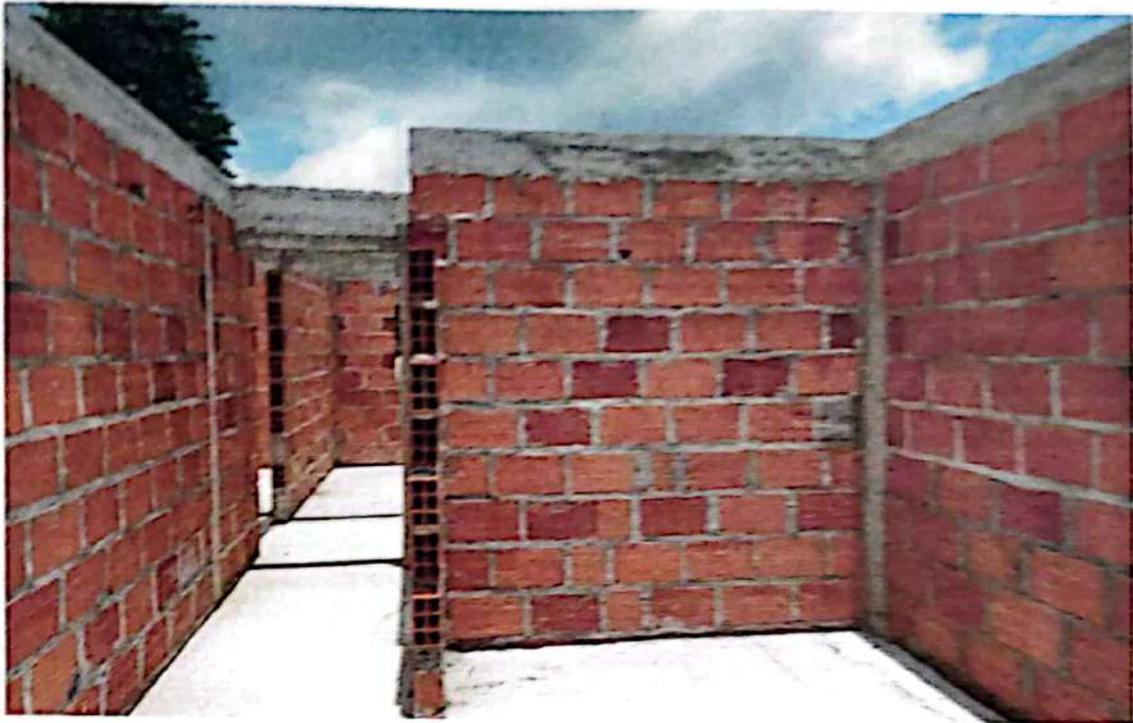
Vista baño tipo terminado en ladrillo H:10 a la altura de viga corona, con vista de vano de ventana.
